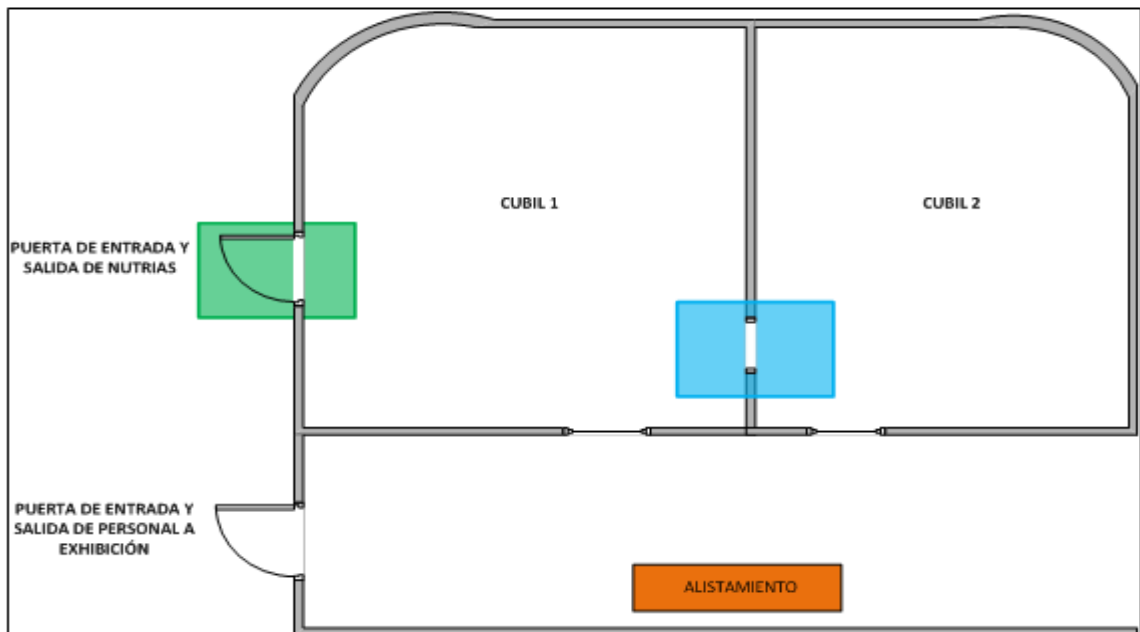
Plano del cubil de las Nutrias con los colores sugeridos para las guillotinas de las puertas
